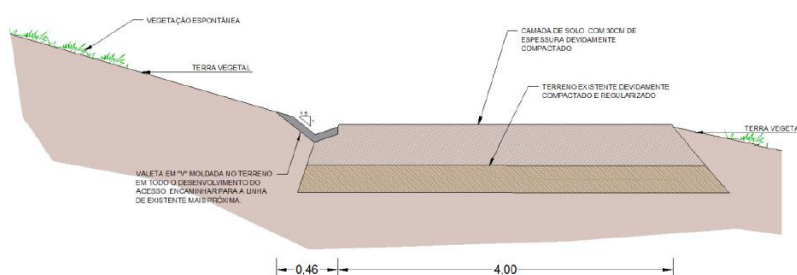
Perfil Transversal tipo do caminho externo (acesso com valeta, a construir/melhorar).
